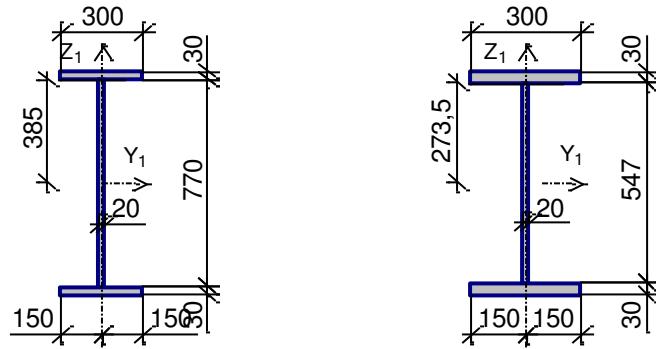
Поперечное сечение несущего ригеля (размеры даны в мм):
